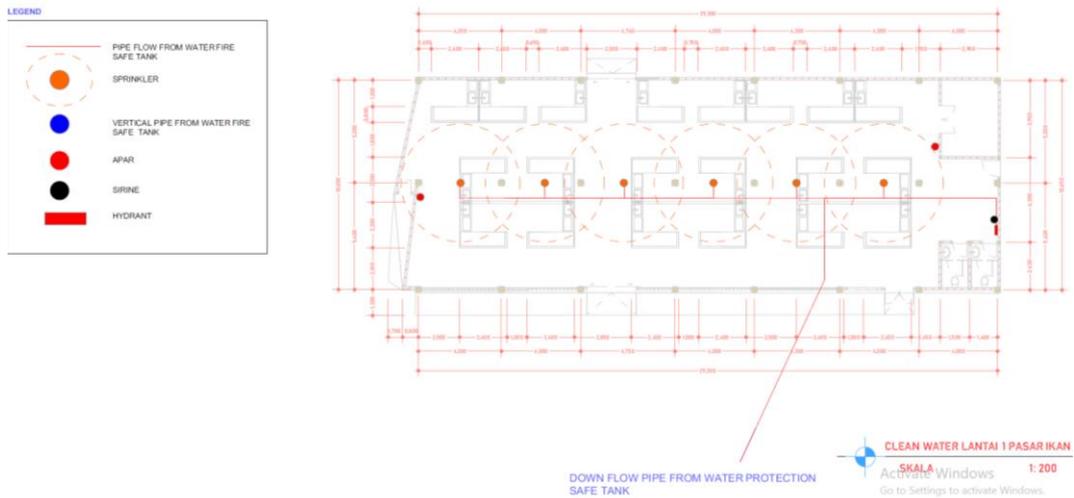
40 Skema fire protection lantai 1 bangunan utama
